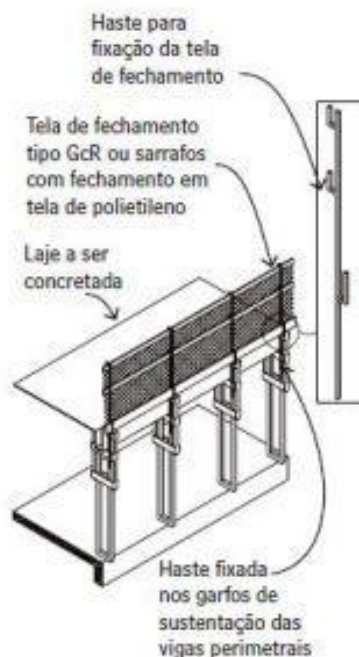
Sistema de apoio do GcR com emprego de vergalhão
